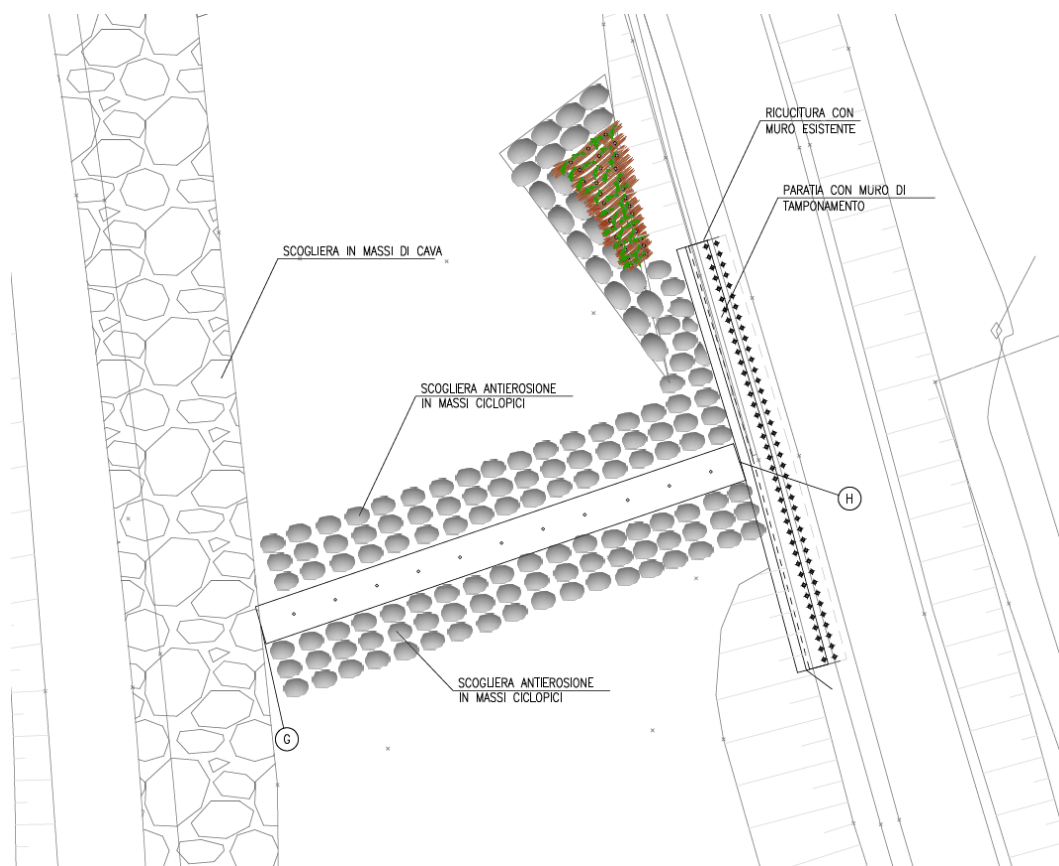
Soglia sotto alveo – Planimetria di progetto
